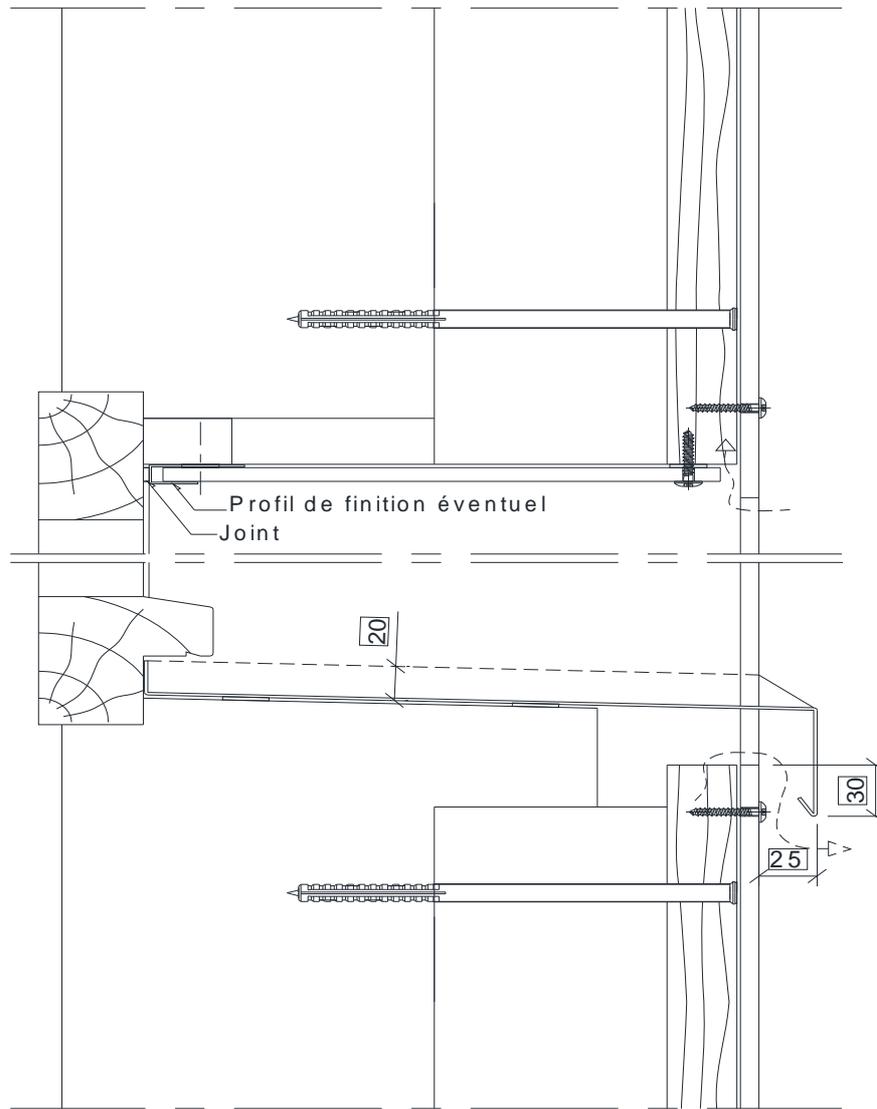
Encadrement de baie avec isolation complémentaire – Coupe verticale - Pose en vêtage
